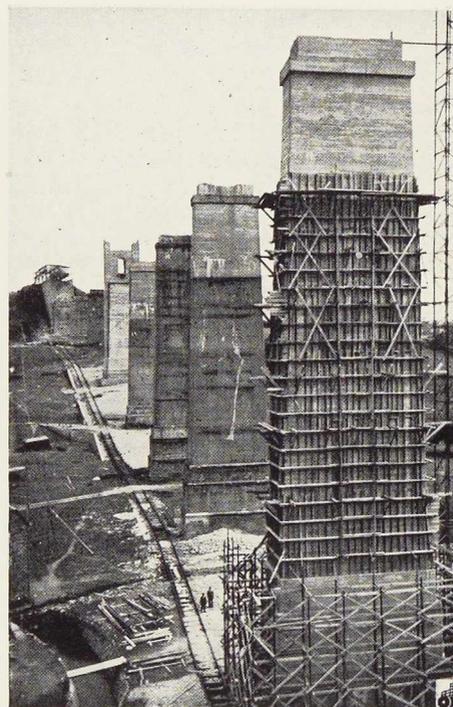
Pile n° 15 reconstruite (à l'avant-plan). Au fond, le pont de service en cours de montage.
